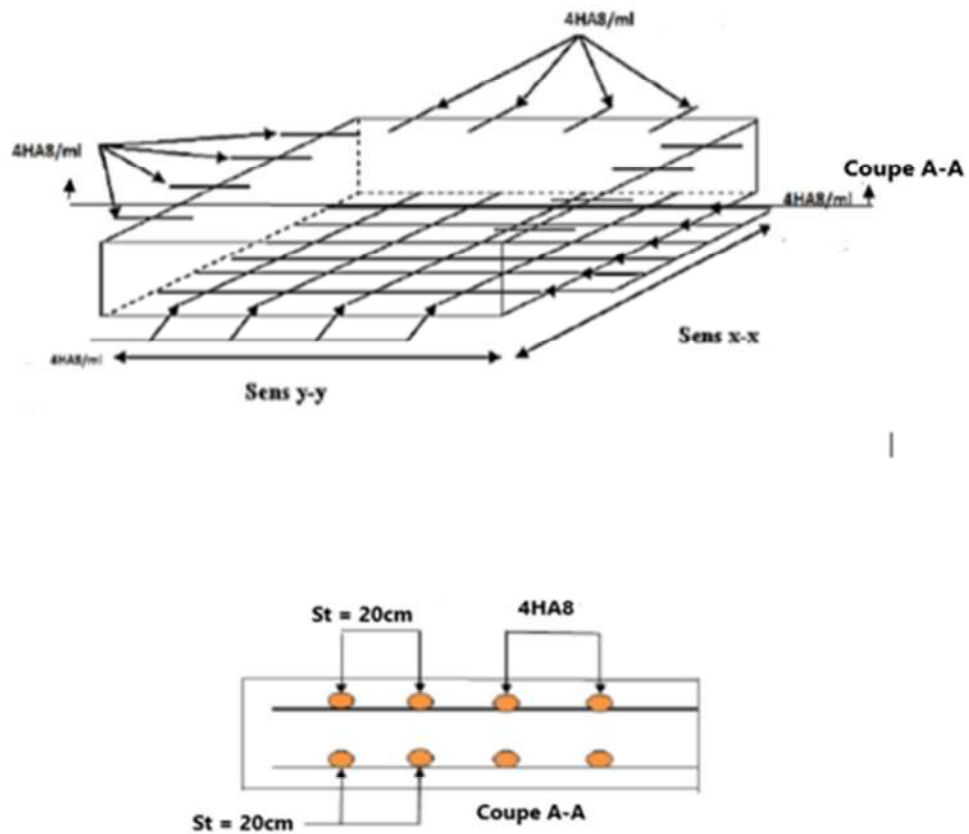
Schéma de ferrailage de panneau (DP3)
